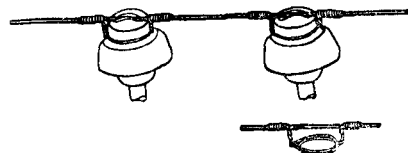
Вязка проводов на двойных траверсах А-образных угловых опор, применяемая для высоковольтных проводов, при установке опор на перегонах, а также для сигнальных проводов, при установке опор на перегонах, станциях и в населённых местах: а—для районов, где нет вибрации проводов, б—для районов, где наблюдается вибрация проводов
